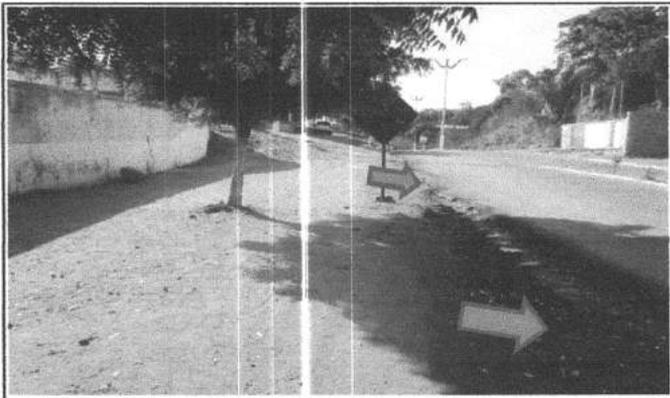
EXECUÇÃO DE CALHA DE DRENAGEM
